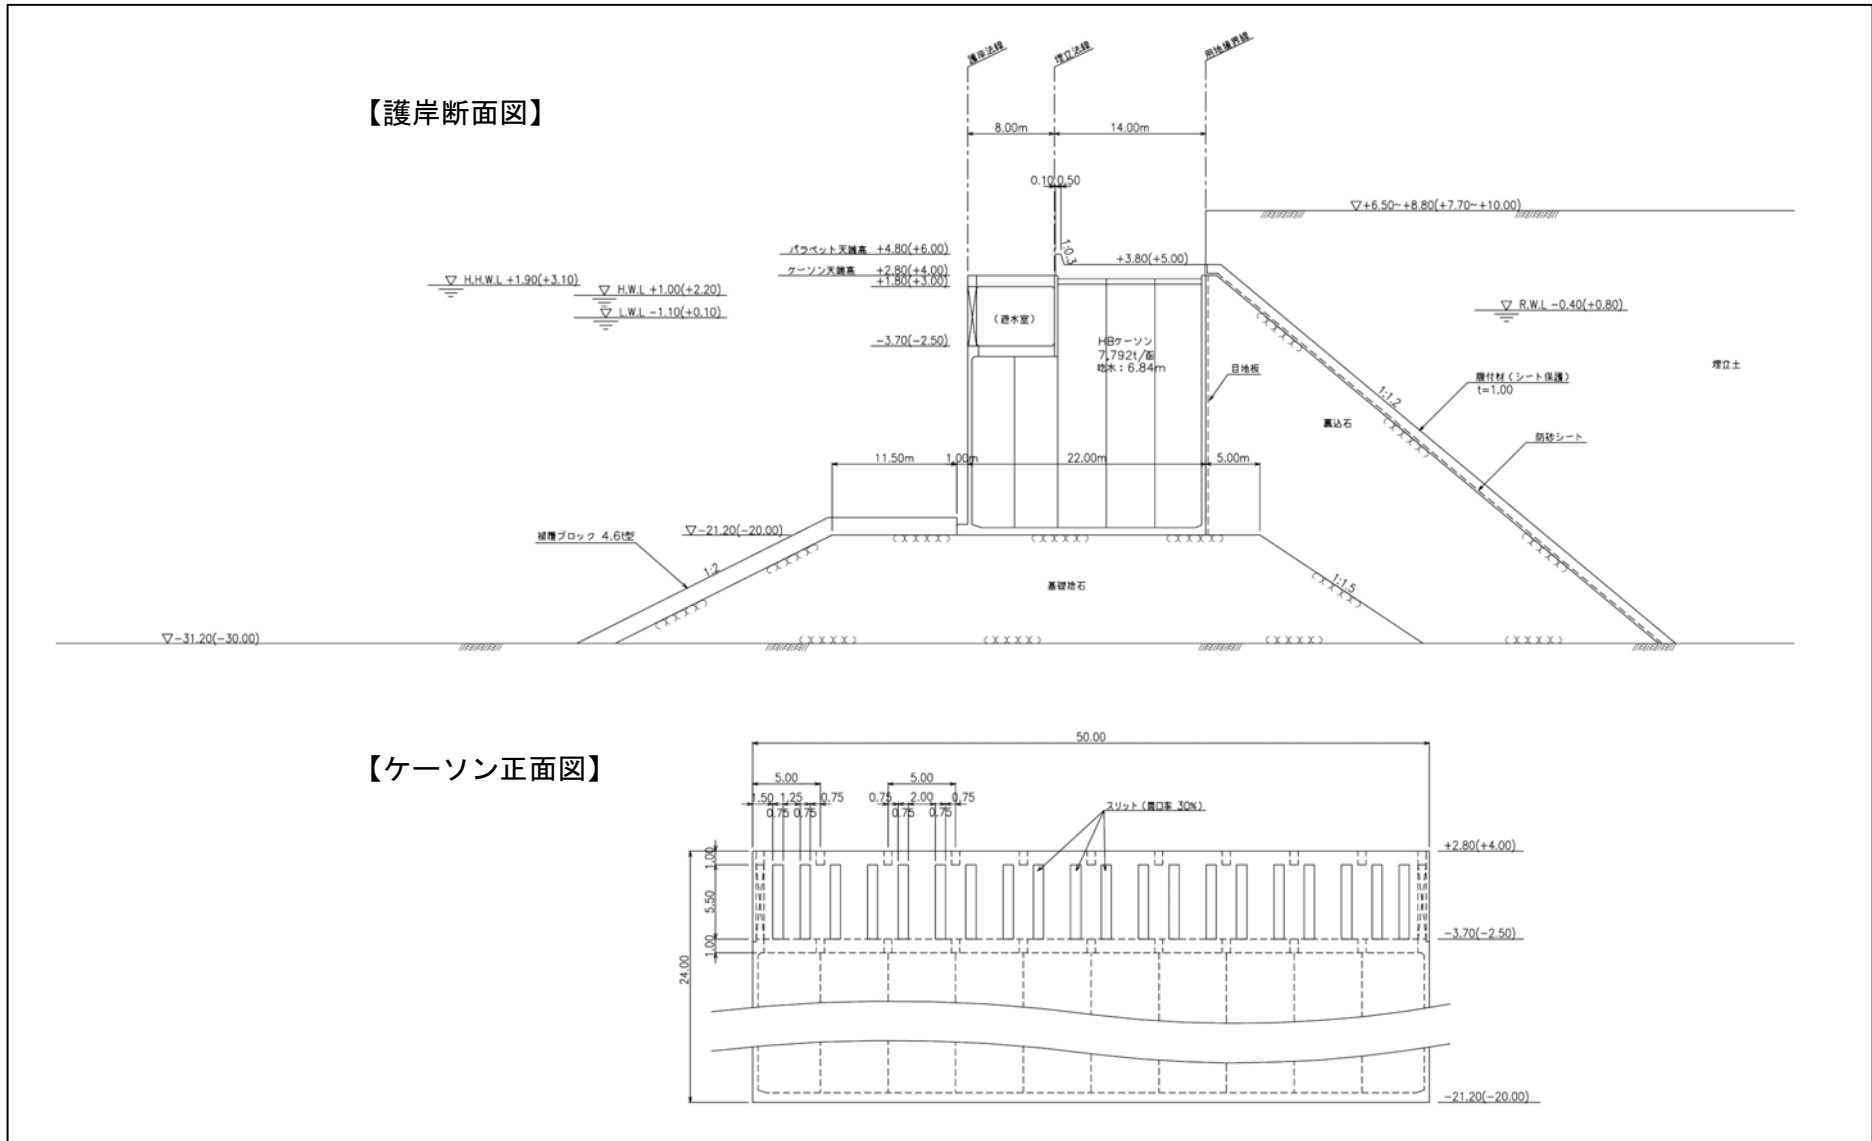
(1) 代替施設本体のケーソン式護岸断面図及びケーソン正面図 (大水深区間)
